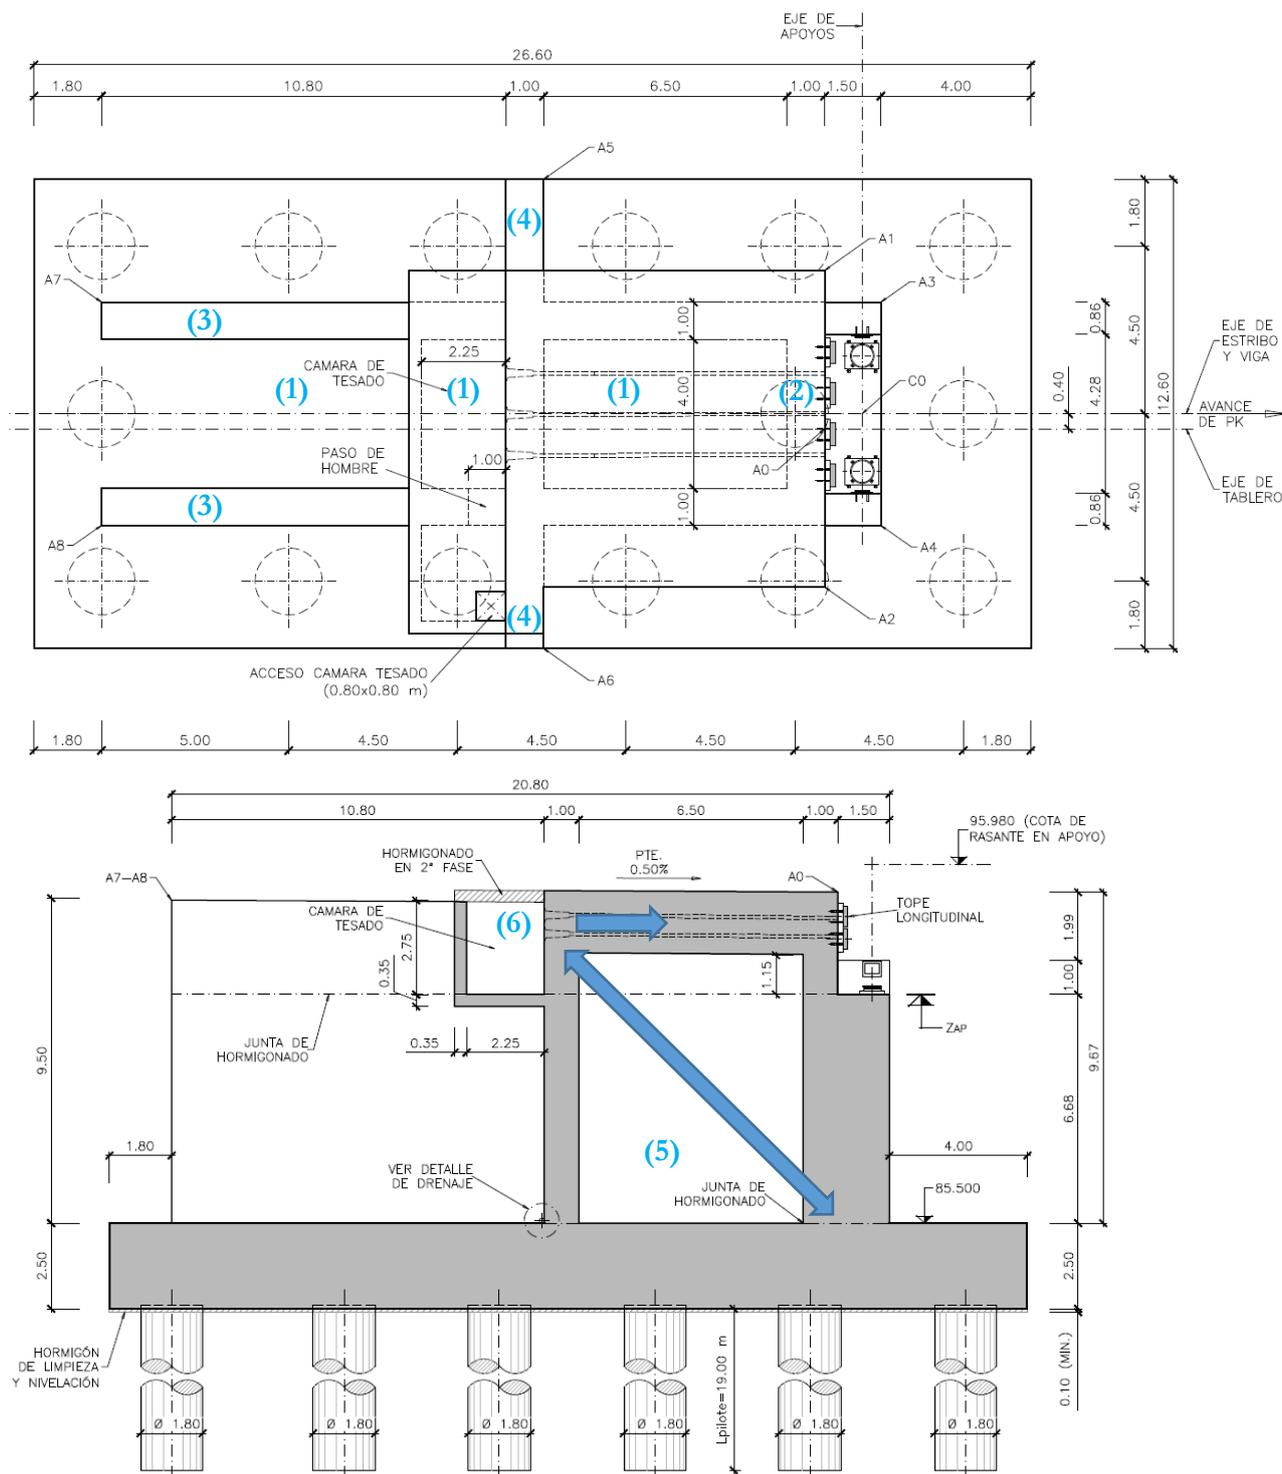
Ejemplo de estribo fijo. Viaducto sobre Rambla de la Sepultura (estribo fijo con máxima carga longitudinal de la L.A.V. Níjar-Almería)
